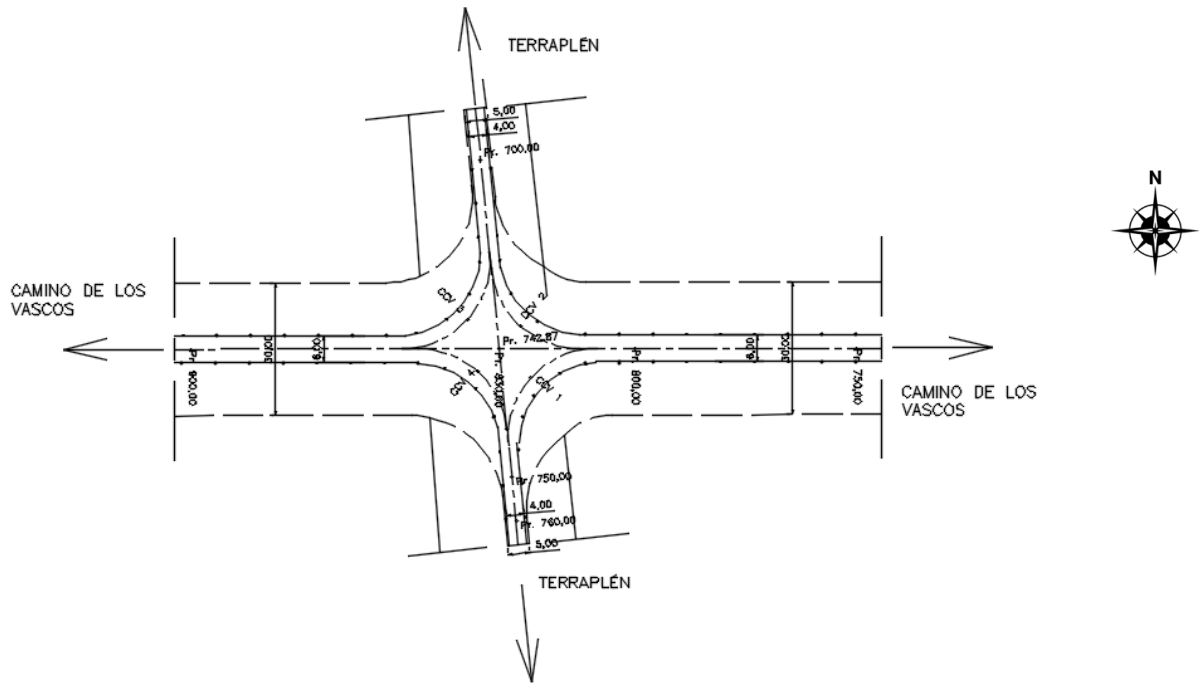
Acceso norte. Planimetría. Fuente: Elaboración propia.
